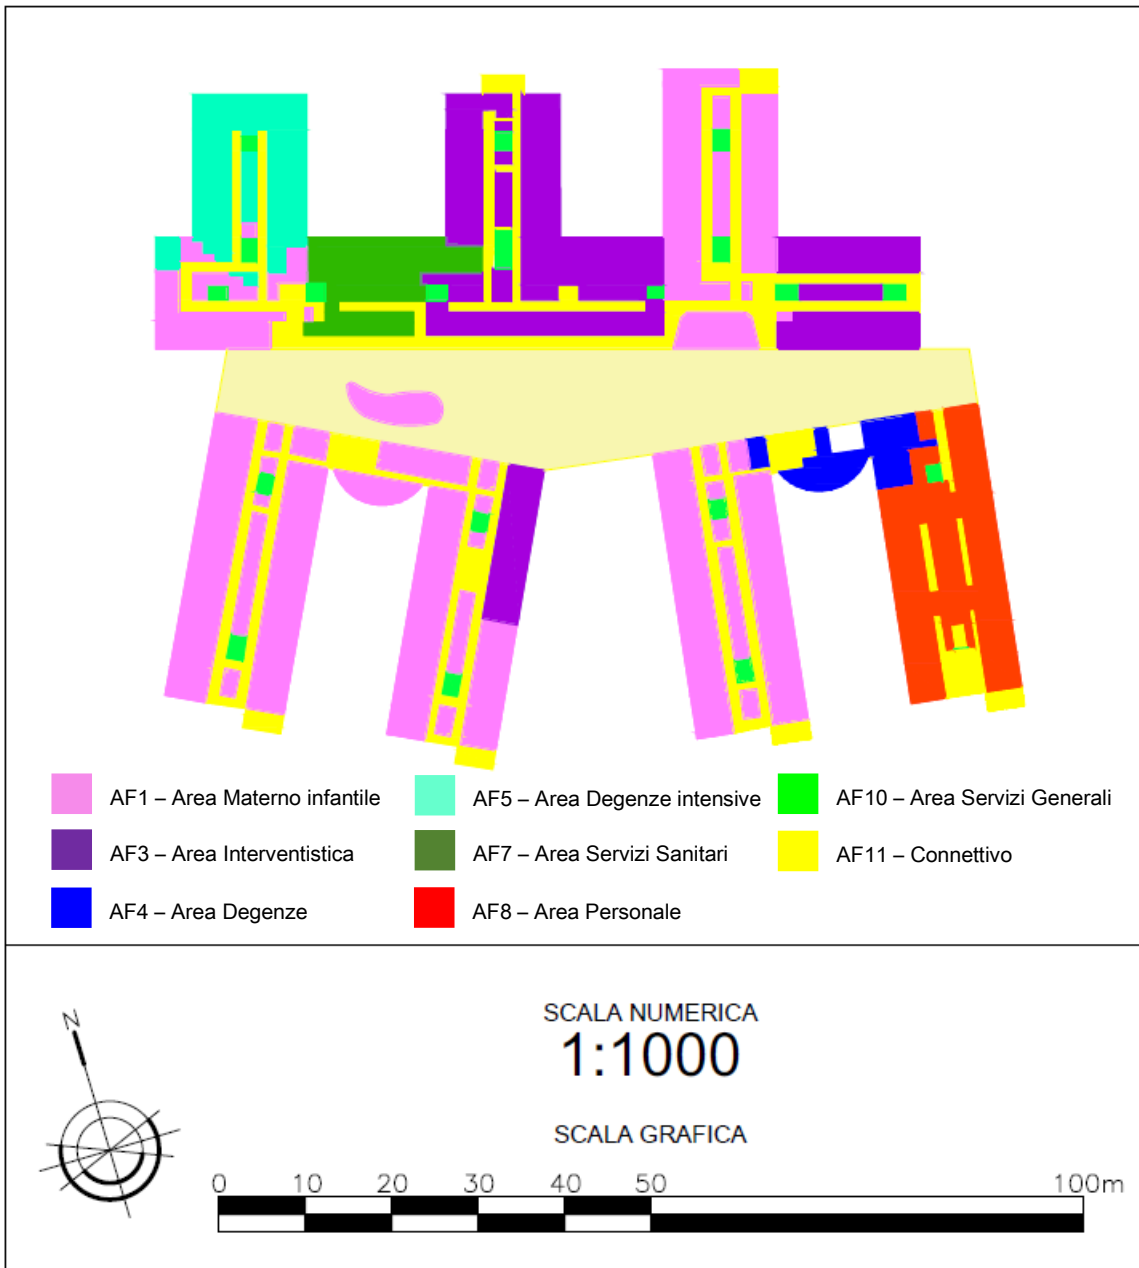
Ospedale Curacao Medical Center - Planimetria Piano Tipo
